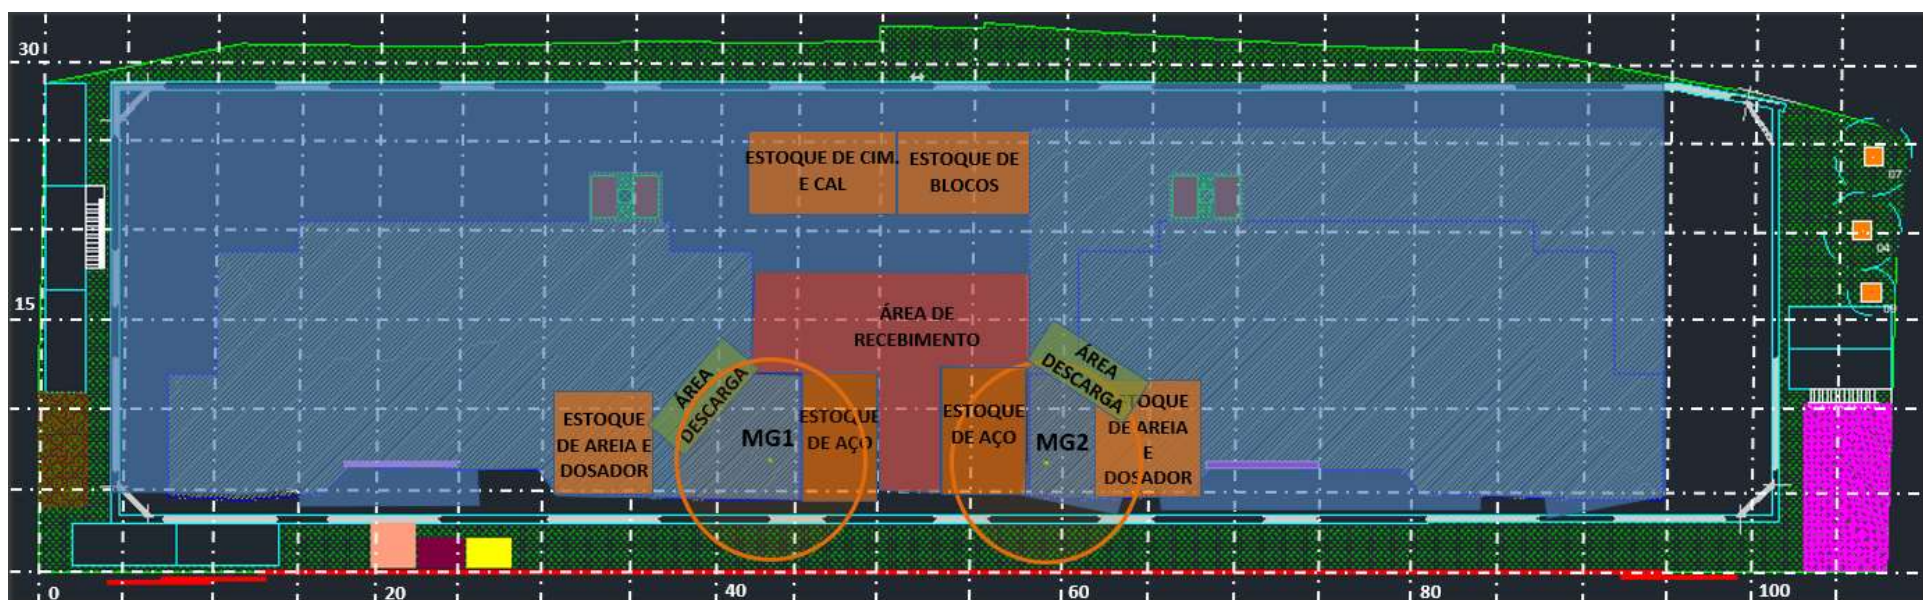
Locação dos elementos do canteiro para análise da Opção 1 (Fonte: Autor)
